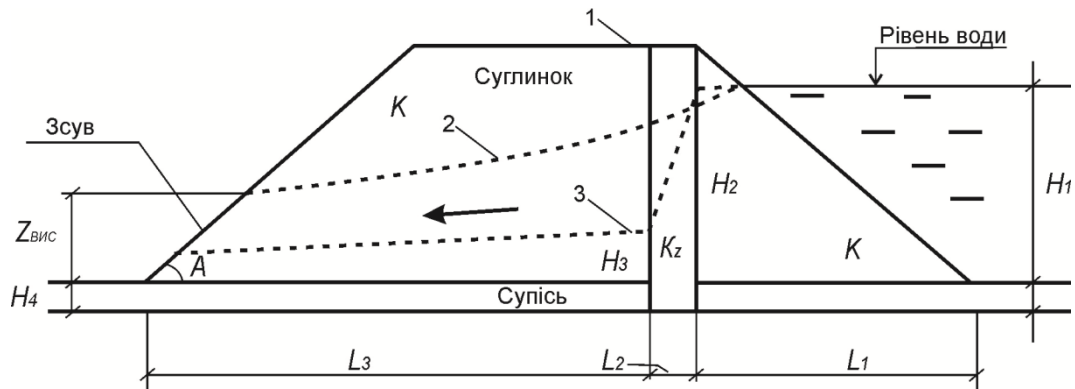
Схема поперечного перерізу ґрунтового насипу
